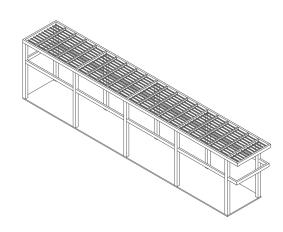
Axonometría estructural tipo 2_4 Fuente: Autores, 2024
